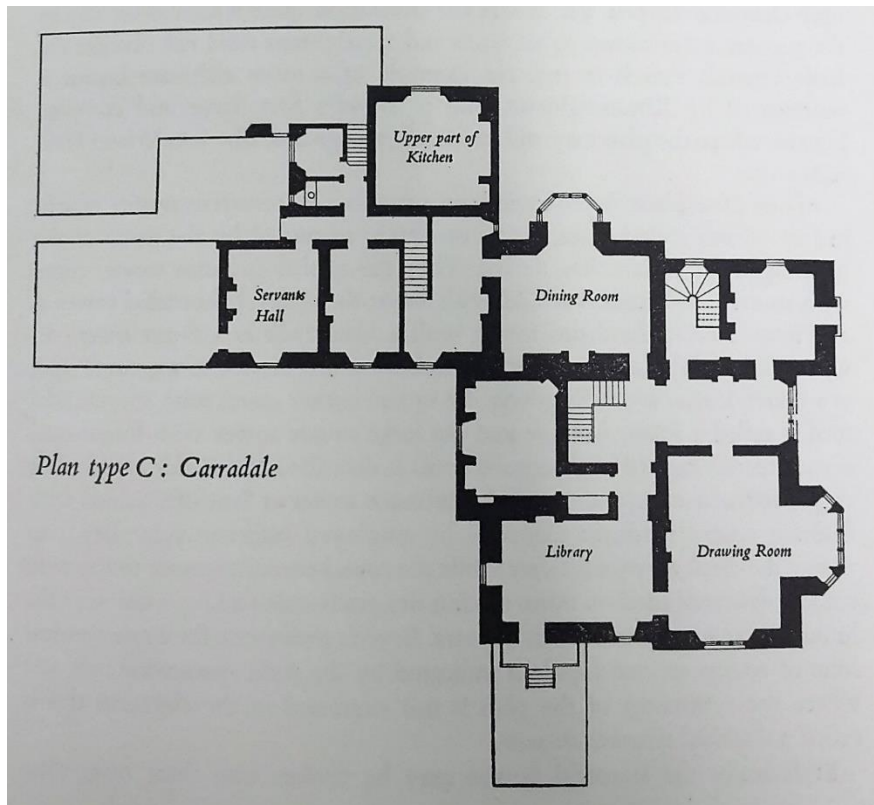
Plan de type C conçu par David Bryce : Carradale House.
